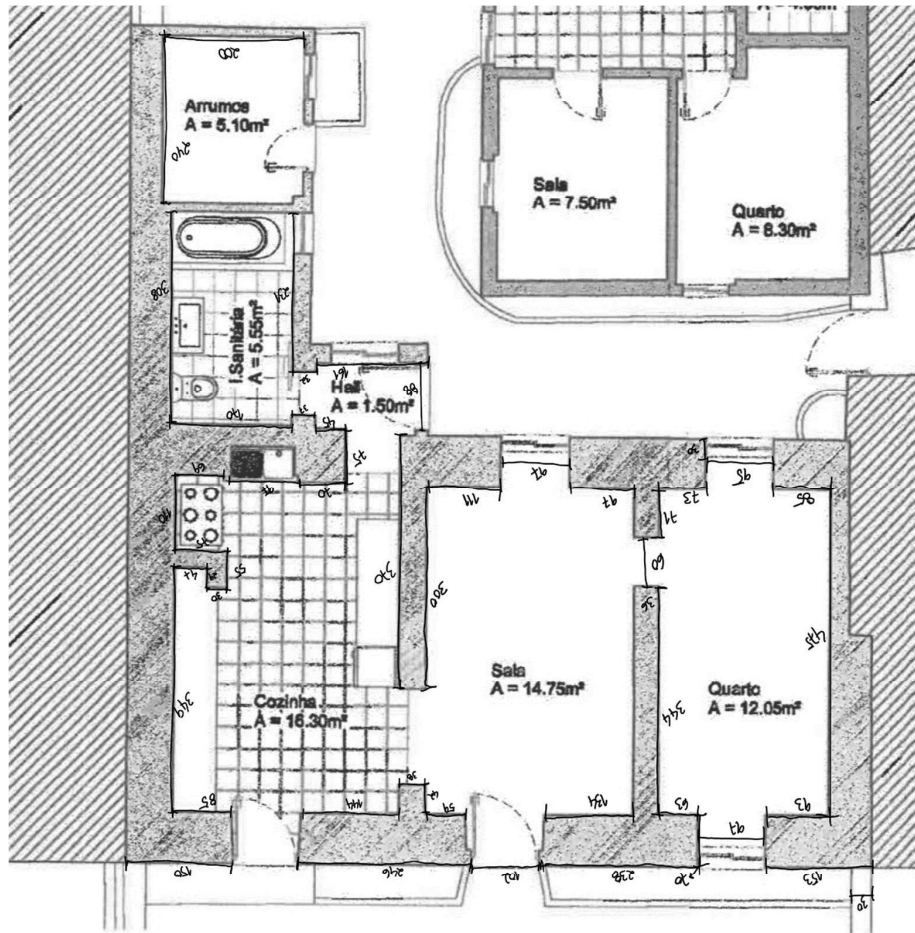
Planta de levantamento. Fonte: Andreia Poim
